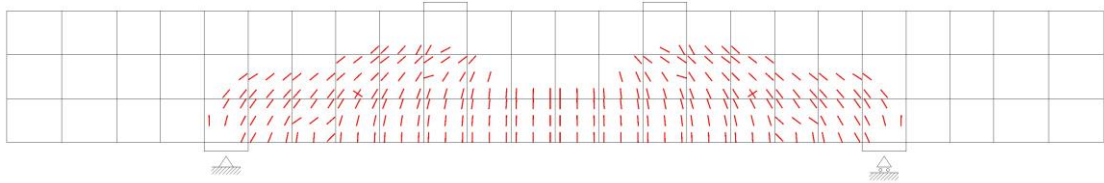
破壊時の変形及びひび割れ状態 (Case No. 1)
